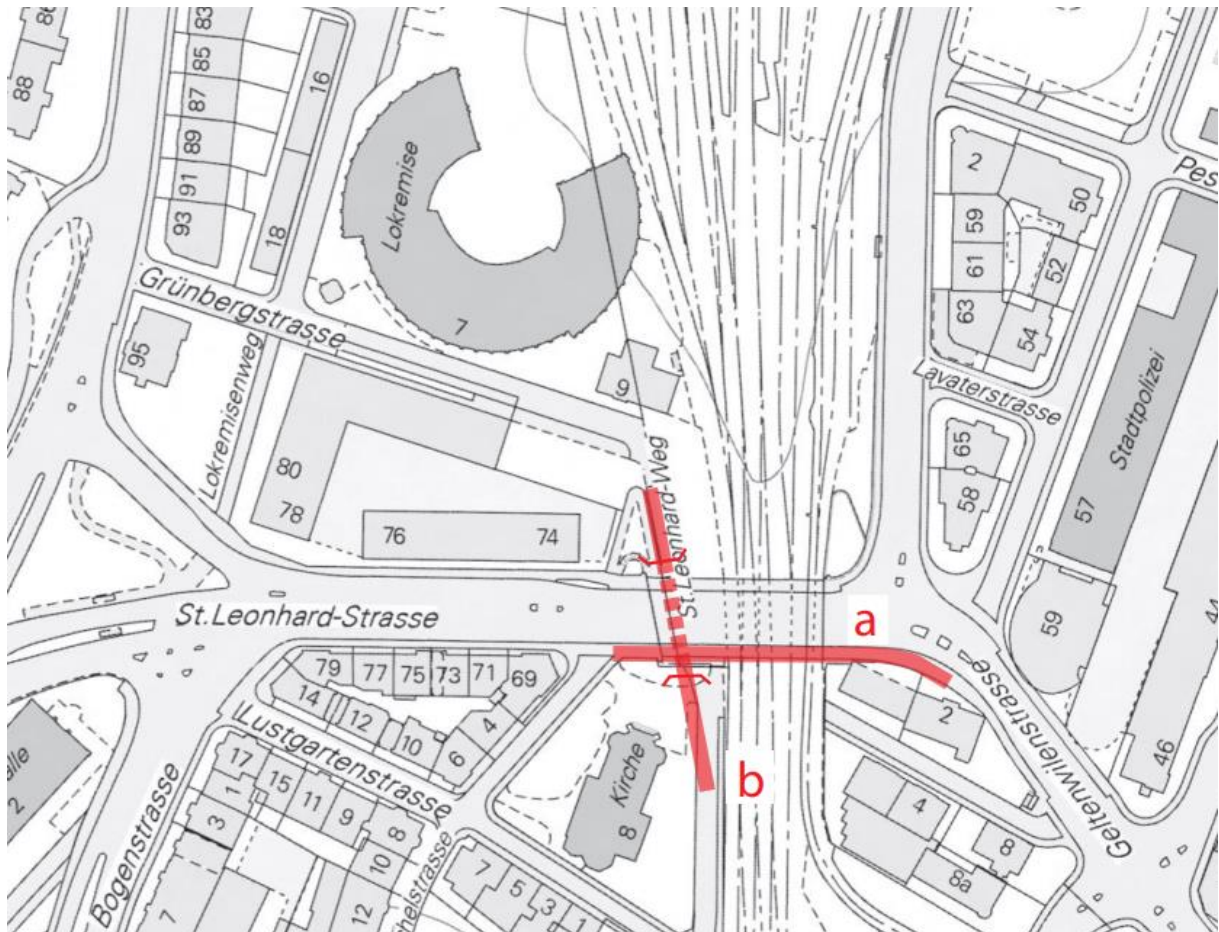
St.Leonhard-Brücke, Brückenverbreiterung inkl. Rampe für den LV: a) Verbreiterung der St.Leonhard-Brücke, b) Verbindung von der Burgstrasse in Richtung Lokremise.
